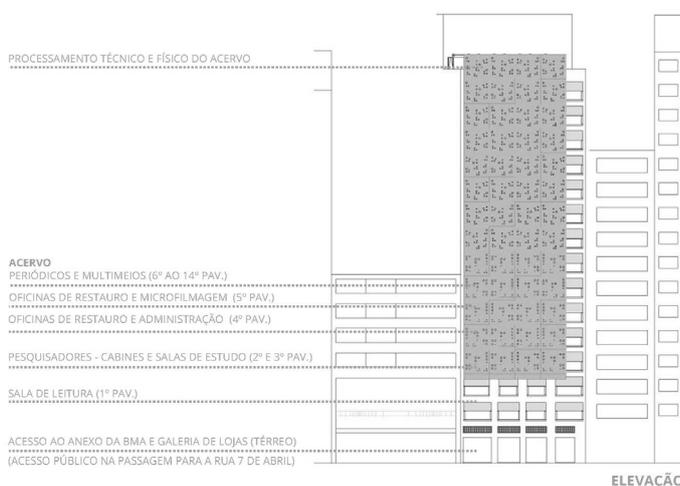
Projeto do anexo da Biblioteca Mário de Andrade. Plantas e elevação (vista da Praça Dom José Gaspar).
